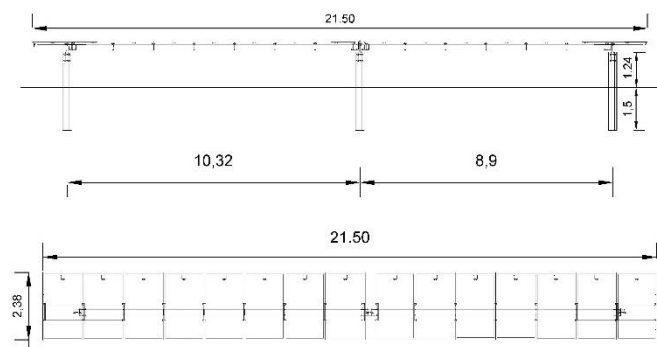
Prospetto frontale e vista in pianta delle strutture (15 moduli) ad inclinazione 0°
